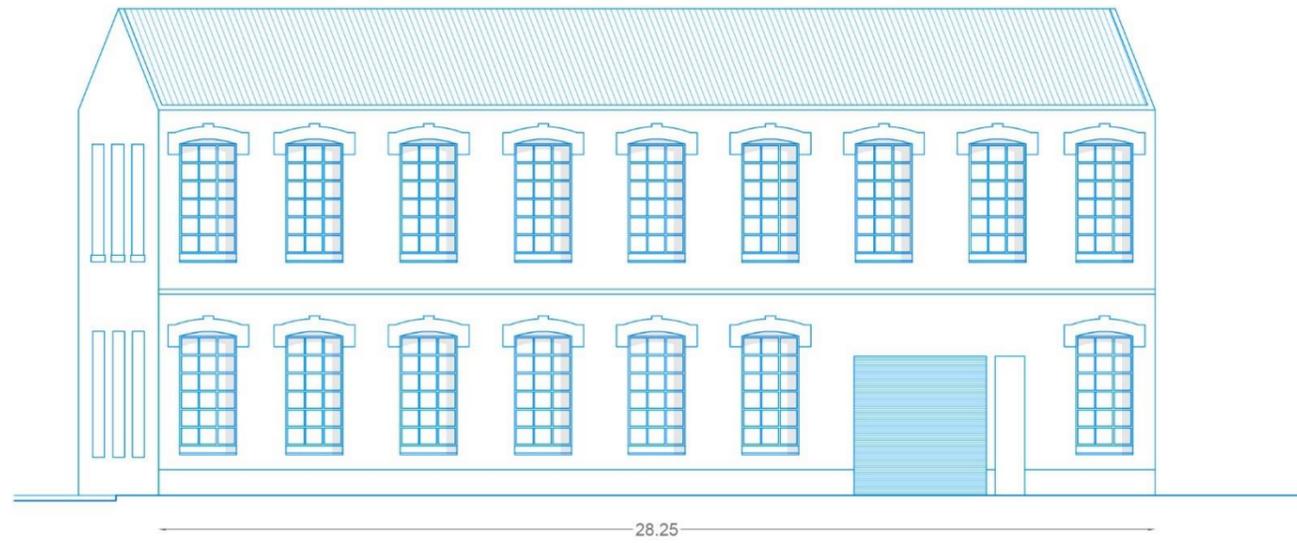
PLANO 1/200. Fachada calle Riego pre intervención nave original fábrica Tort Can Planell. Fuente: Elaboración propia.
